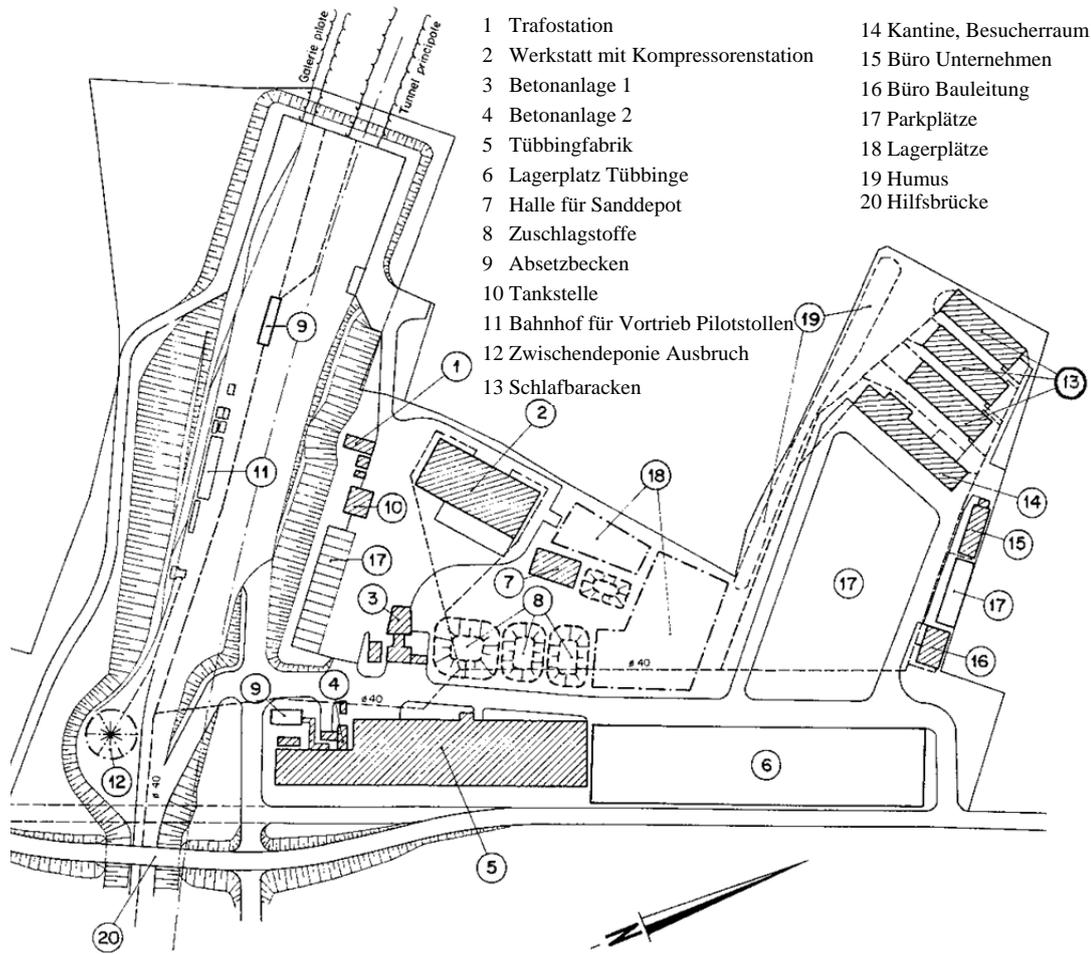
Baustelleneinrichtungsplan einer Tunnelbaustelle
